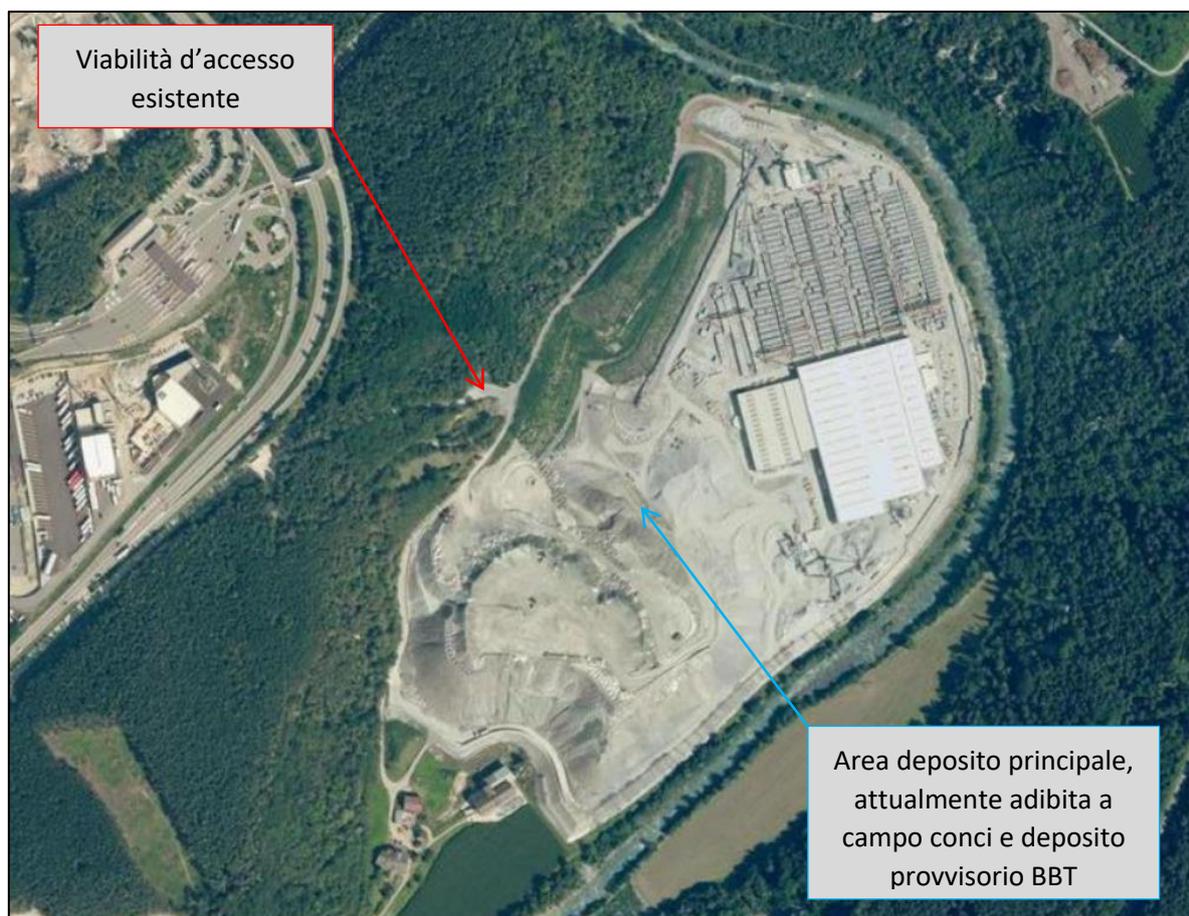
Planimetria area di cantiere BBT e deposito provvisorio – Civis map ortofoto 2020 (Provincia Autonoma di Bolzano)
